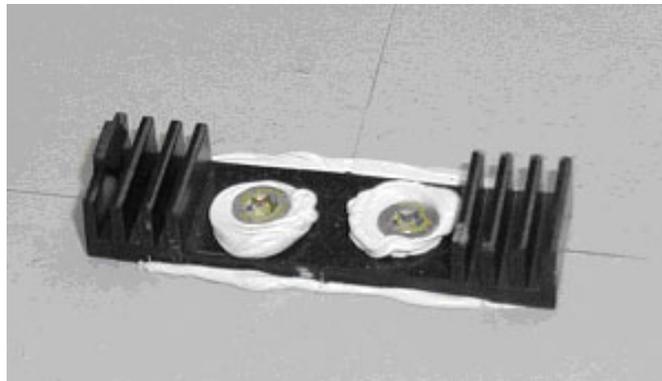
Etanchéité locale de Jupit'air® sur résine polyuréthane assurant une étanchéité de la terrasse.
